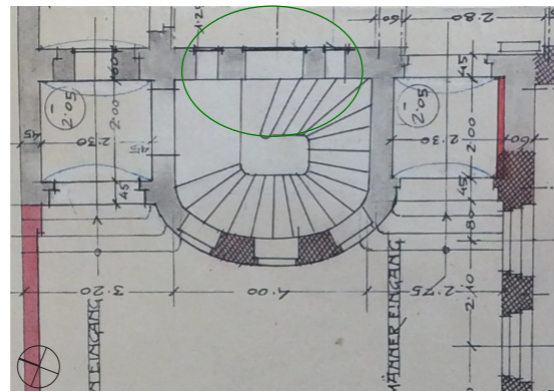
Grundriss Auswechslung (11/1907) [ma37]
